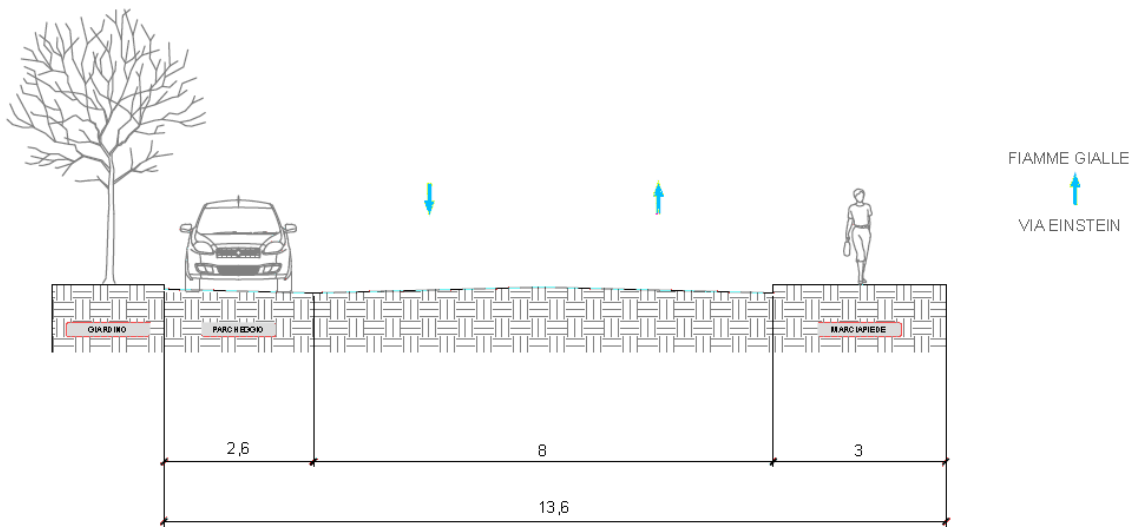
Sezione tipo Via Enrico Fermi – stato attuale
